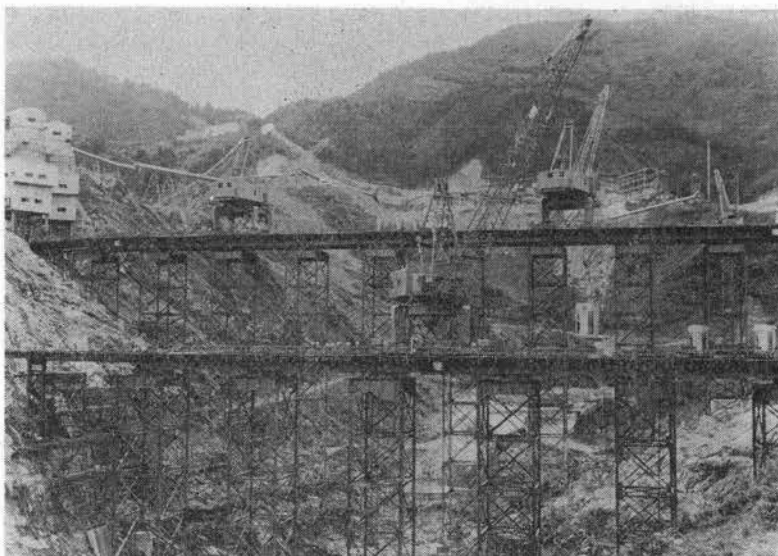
ジブクレーンによるコンクリート打設(下久保ダム)
